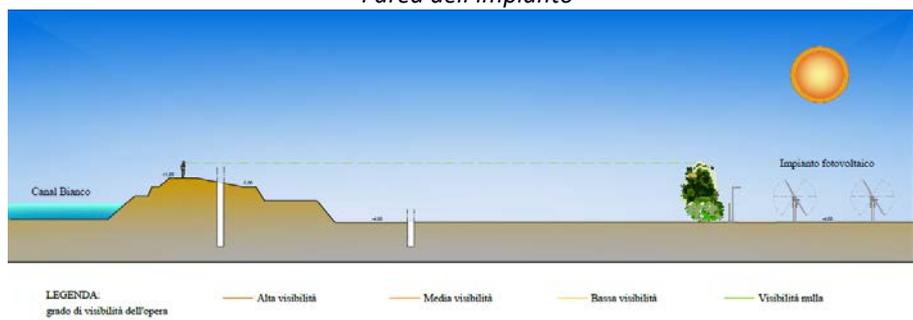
Sezione di intervisibilità dal punto di vista chiave n. 6 dal lato nord, dall'argine dx del ramo morto del Canalbianco (località Retinella)
